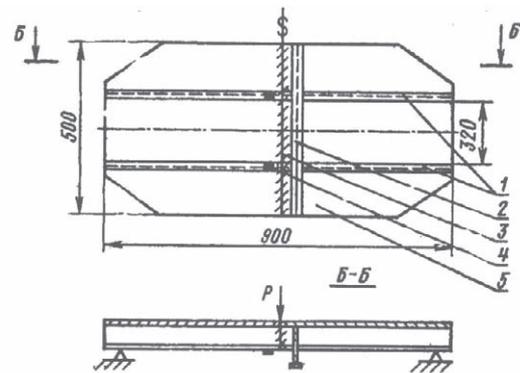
Образец для испытаний на поперечный циклический изгиб:
